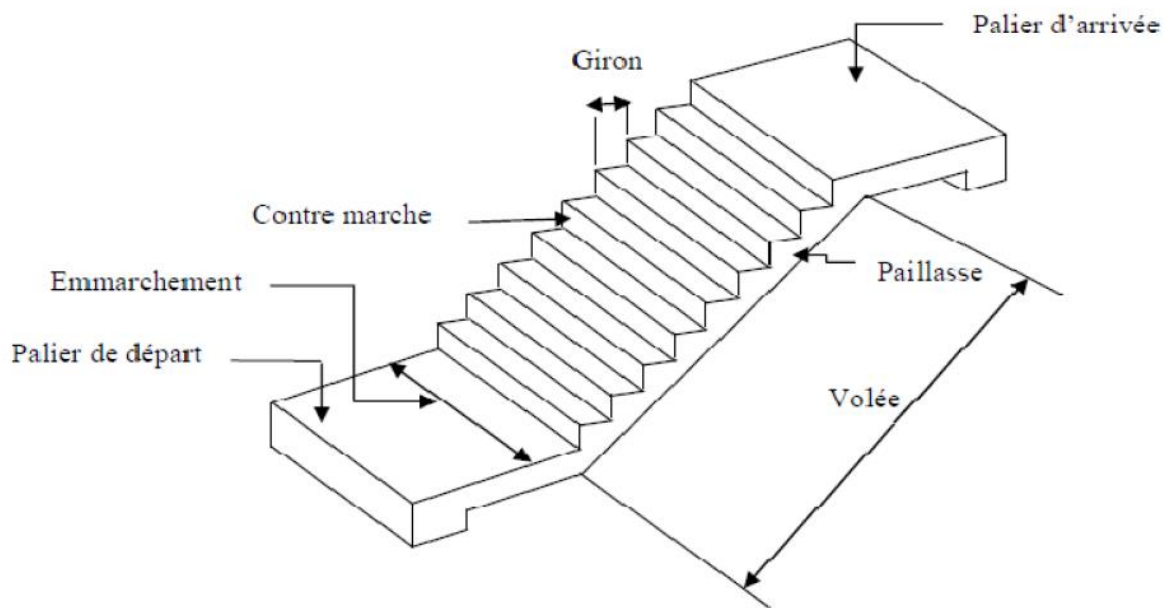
Schéma général d'une volée d'un escalier droit.
